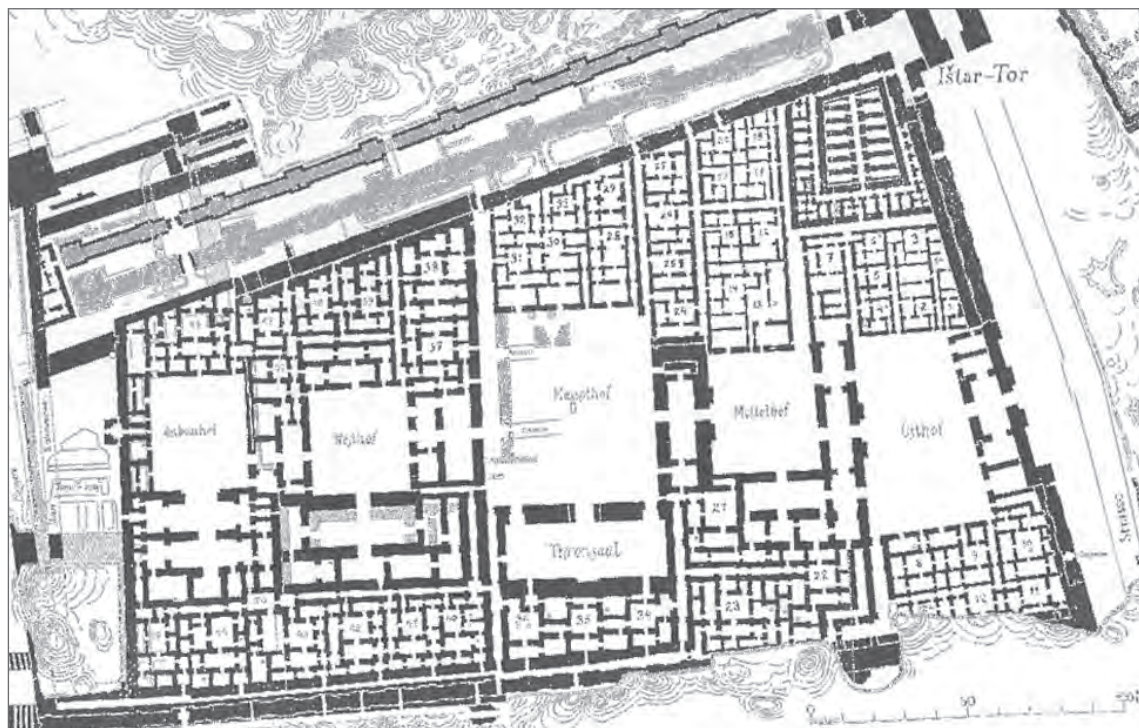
Plan du Palais Sud (Koldewey, 1931 : planche 2).
